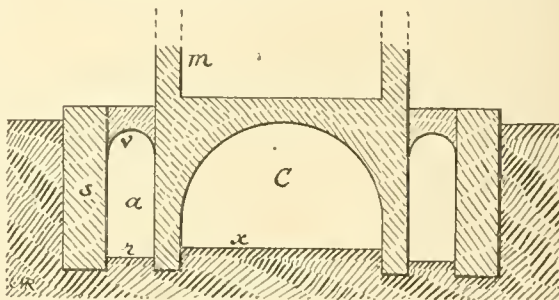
Coupe transversale d'une cave avec galeries extérieures.
